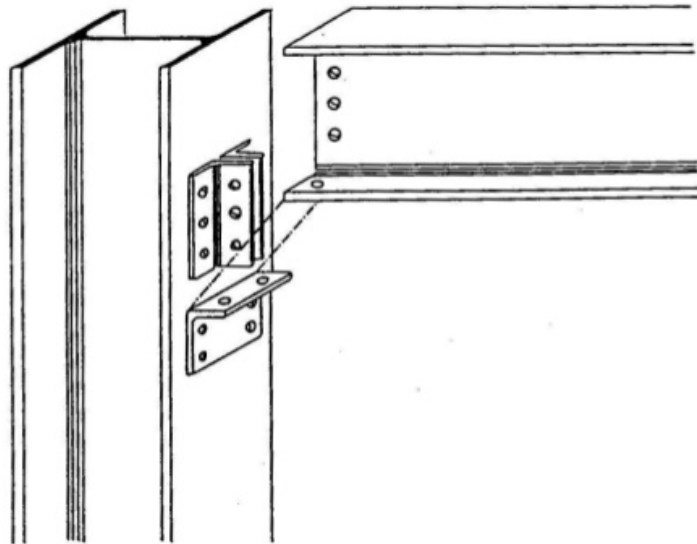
Unión columna y viga. https://es.slideshare.net/pax_paks/vigas-acero
